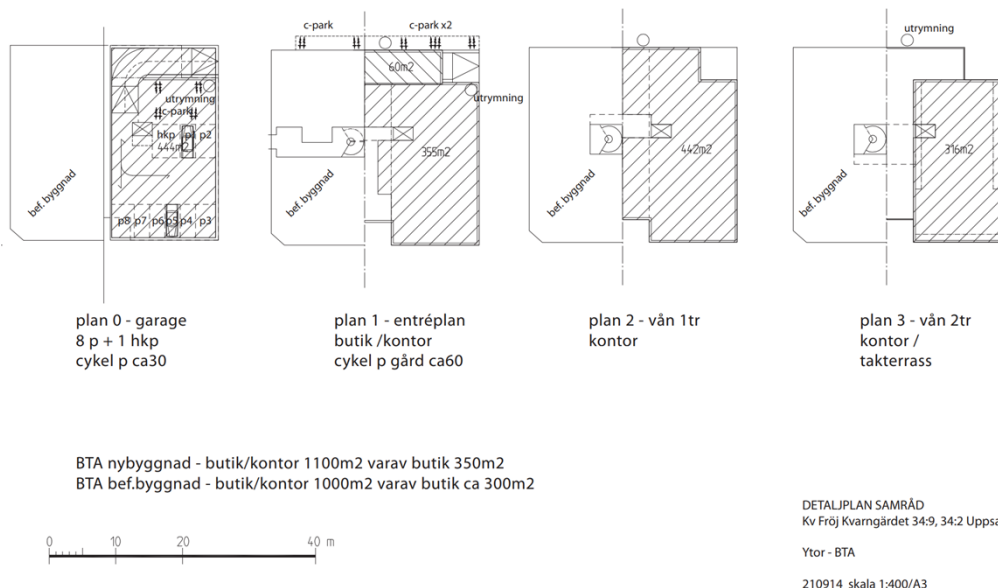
Planritningar över samtliga våningsplan (VESPR AB 2021-09-30).
